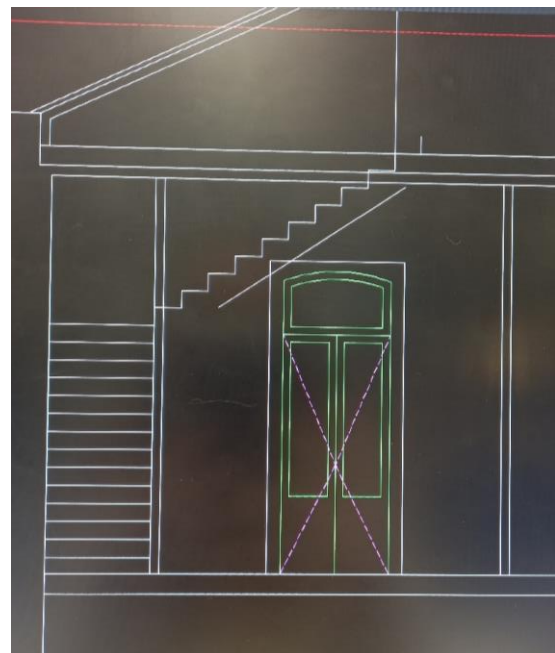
Laje da escada. Fonte: Atelier Studio Arte.
